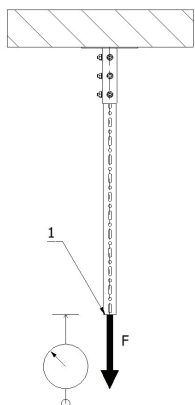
Configurazione di prova del momento flettente alla piastra a soffitto / *Test set-up for bending moment at the ceiling plate
